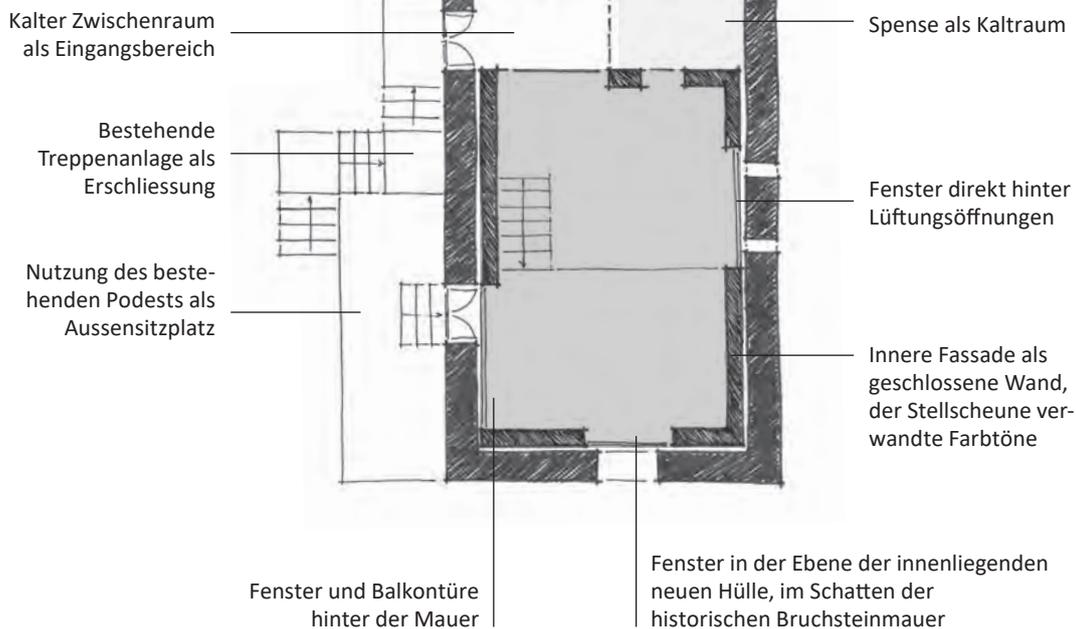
«Haus im Stall»-Prinzip bei steinernen Stallscheunen. Systemdarstellung im Grundriss.
